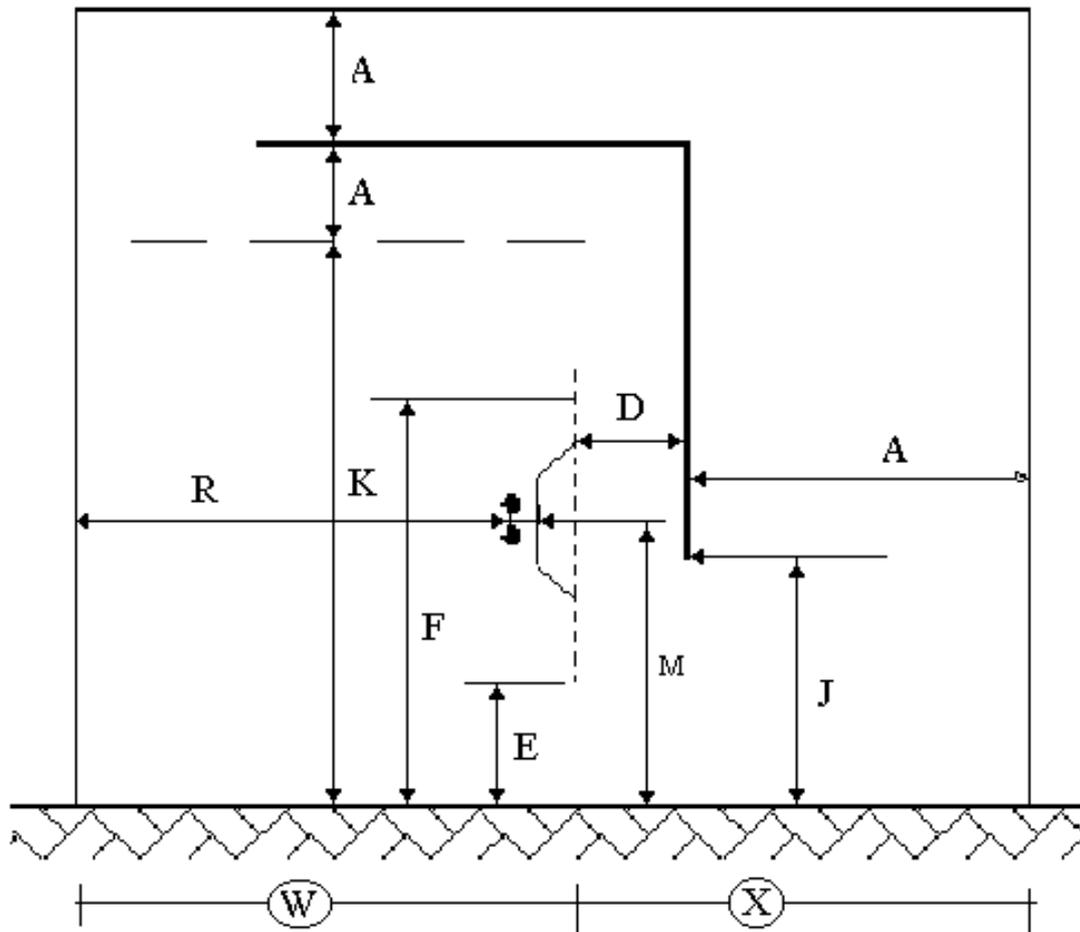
(a) – Espaçamento para instalações internas – circulação por um lado
